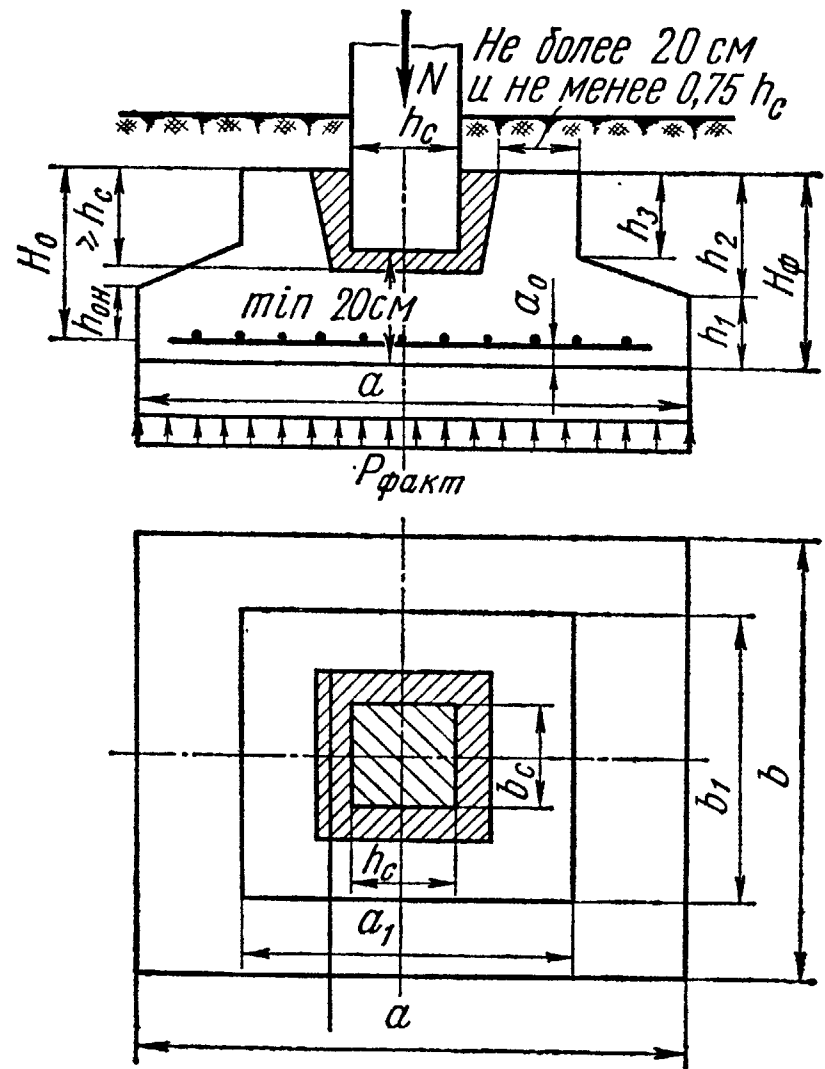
Столбчатый фундамент в виде стакана под колонны
